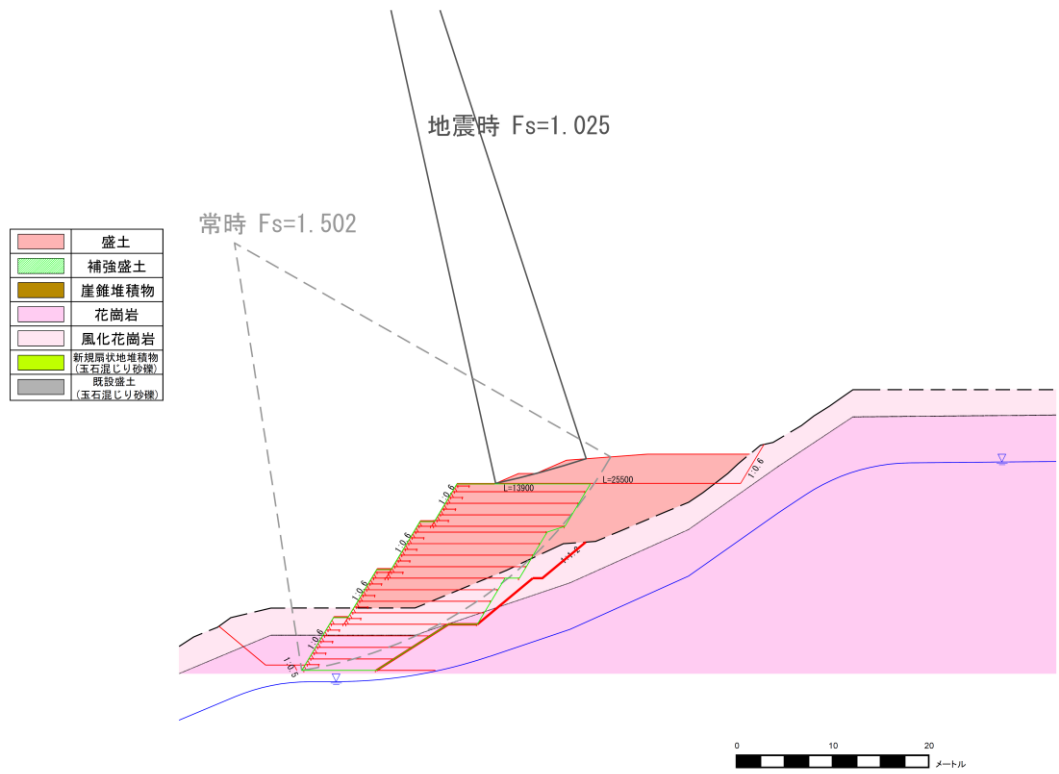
(1) 土地の安定性の検討断面図(1-1)
